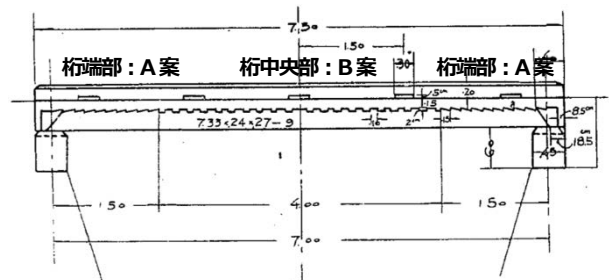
木コンクリート桁の設計側面図 (文献³⁾より転載・加筆)
